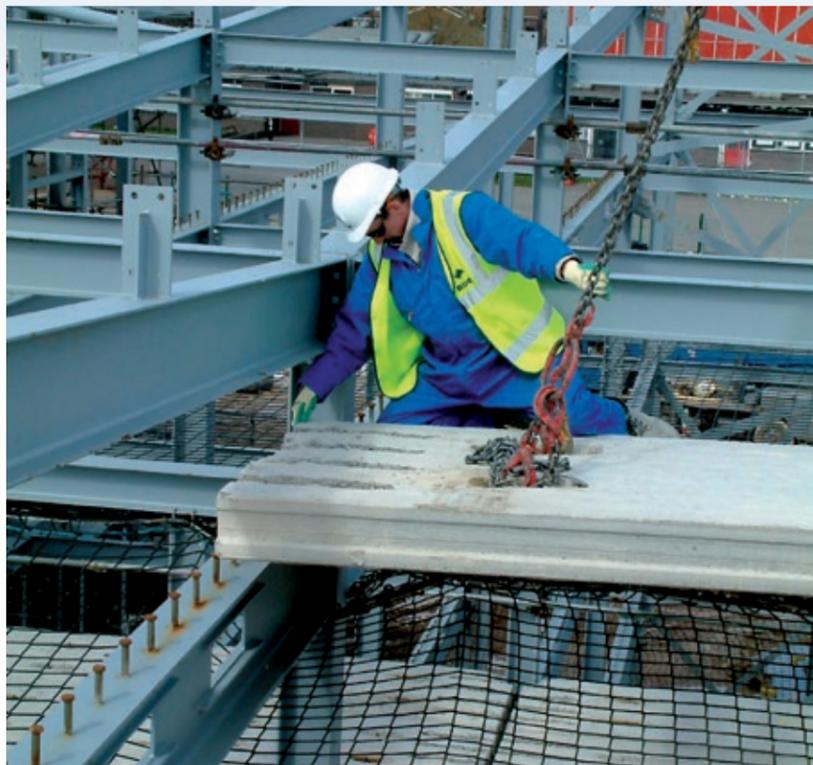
Применение сборных железобетонных плит, опирающихся на стальные балки
